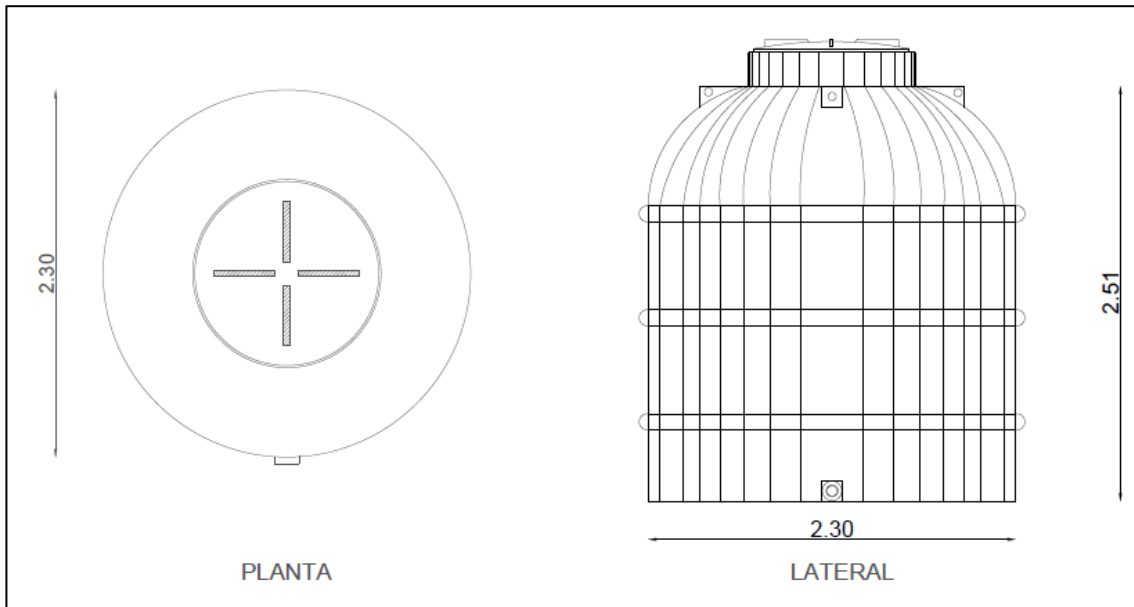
Tanque de 8000 L, vista frontal y en planta
